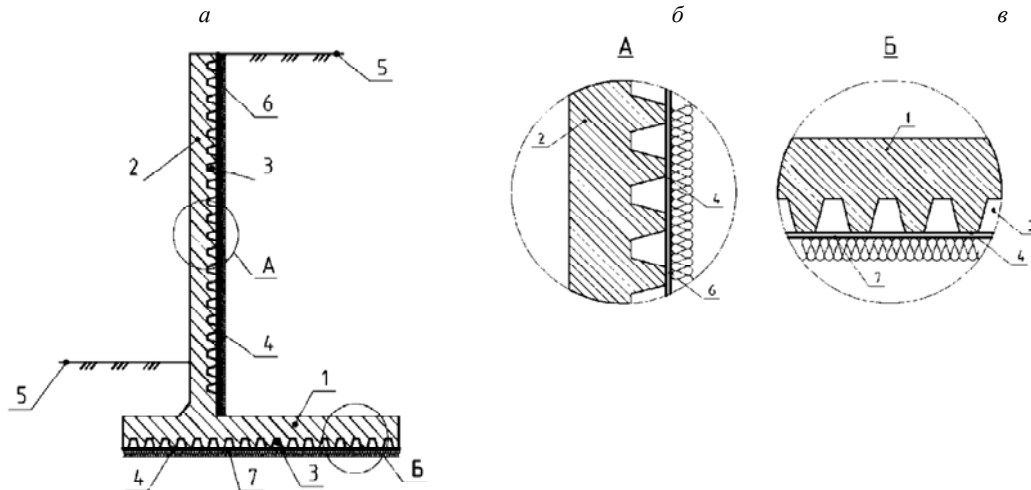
Монолитная подпорная стена специального типа: а – поперечный разрез; б – узел А; в – узел В;
